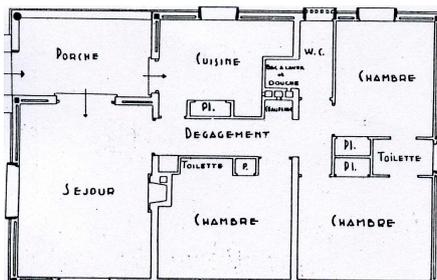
Plan d'une villa individuelle. Figure 1.23 : Plan d'étage de l'immeuble collectif.
